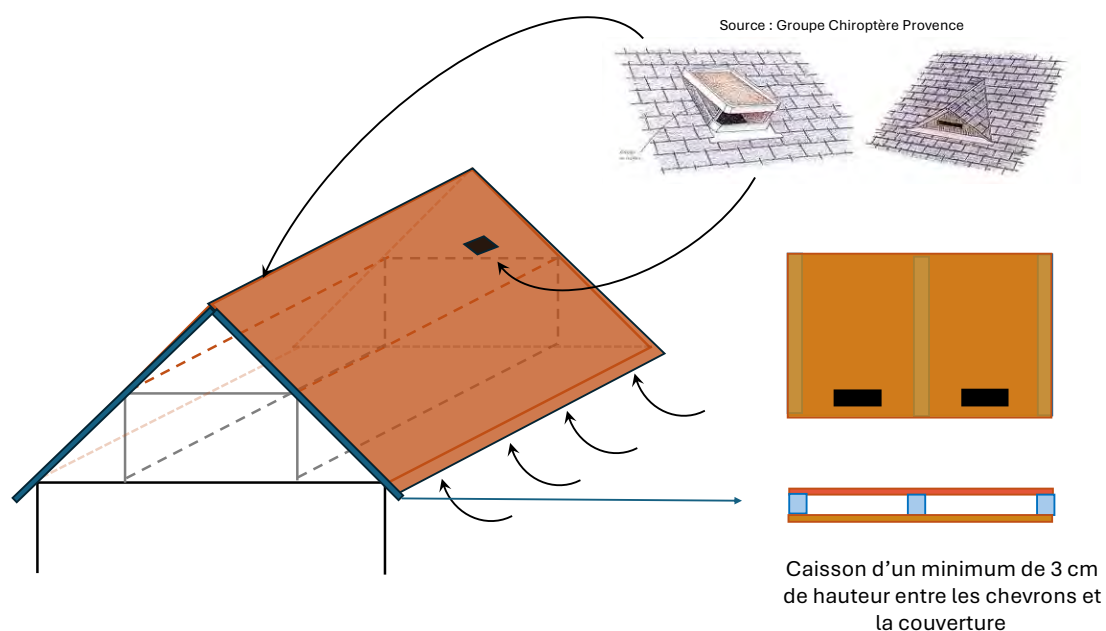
Schémas d'aménagements et des accès aux caissons sous toiture
